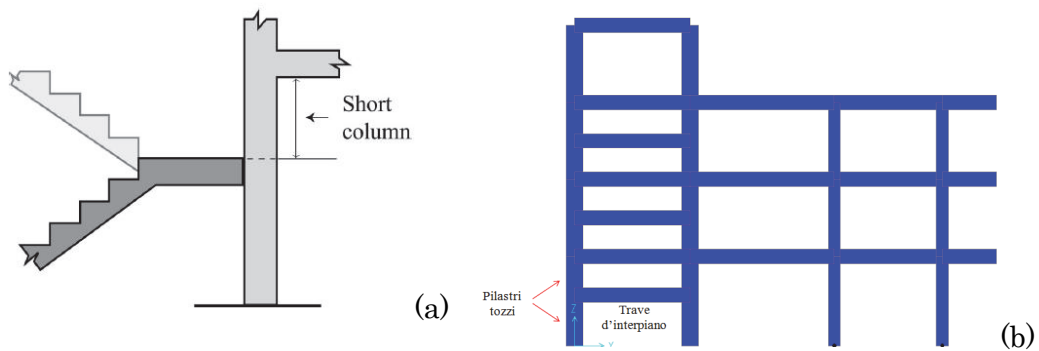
Schema di pilastro tozzo dovuto alla presenza della trave d'interpiano (a); telaio della struttura in esame con modellazione del pilastro tozzo (b)
